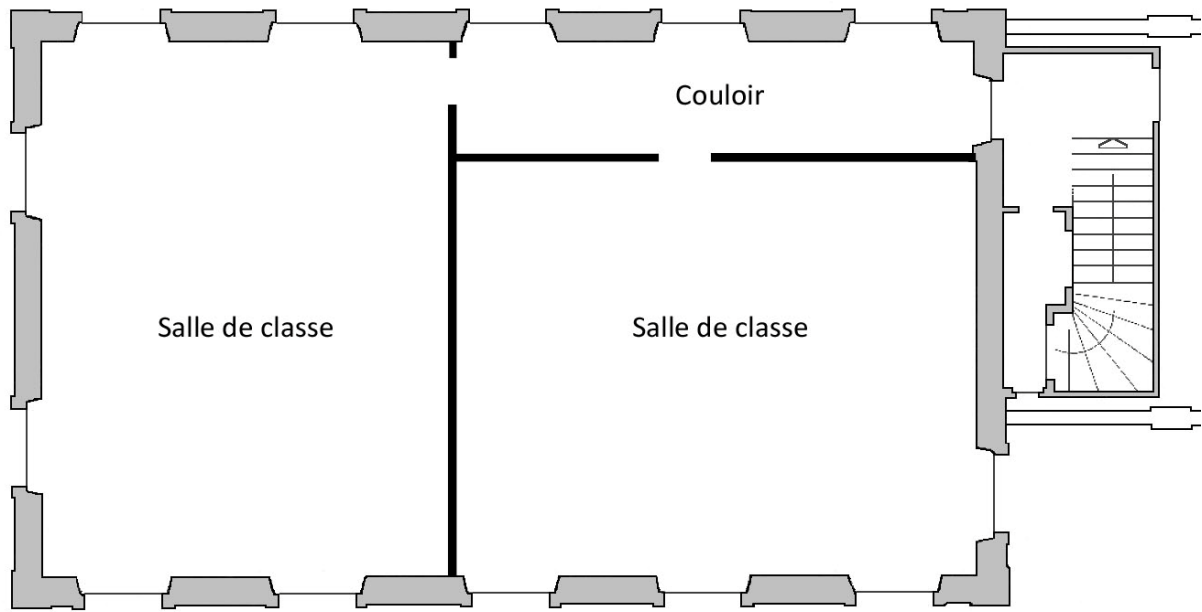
Collège de la Promenade, plan du projet 1^{er} étage aile ouest.
